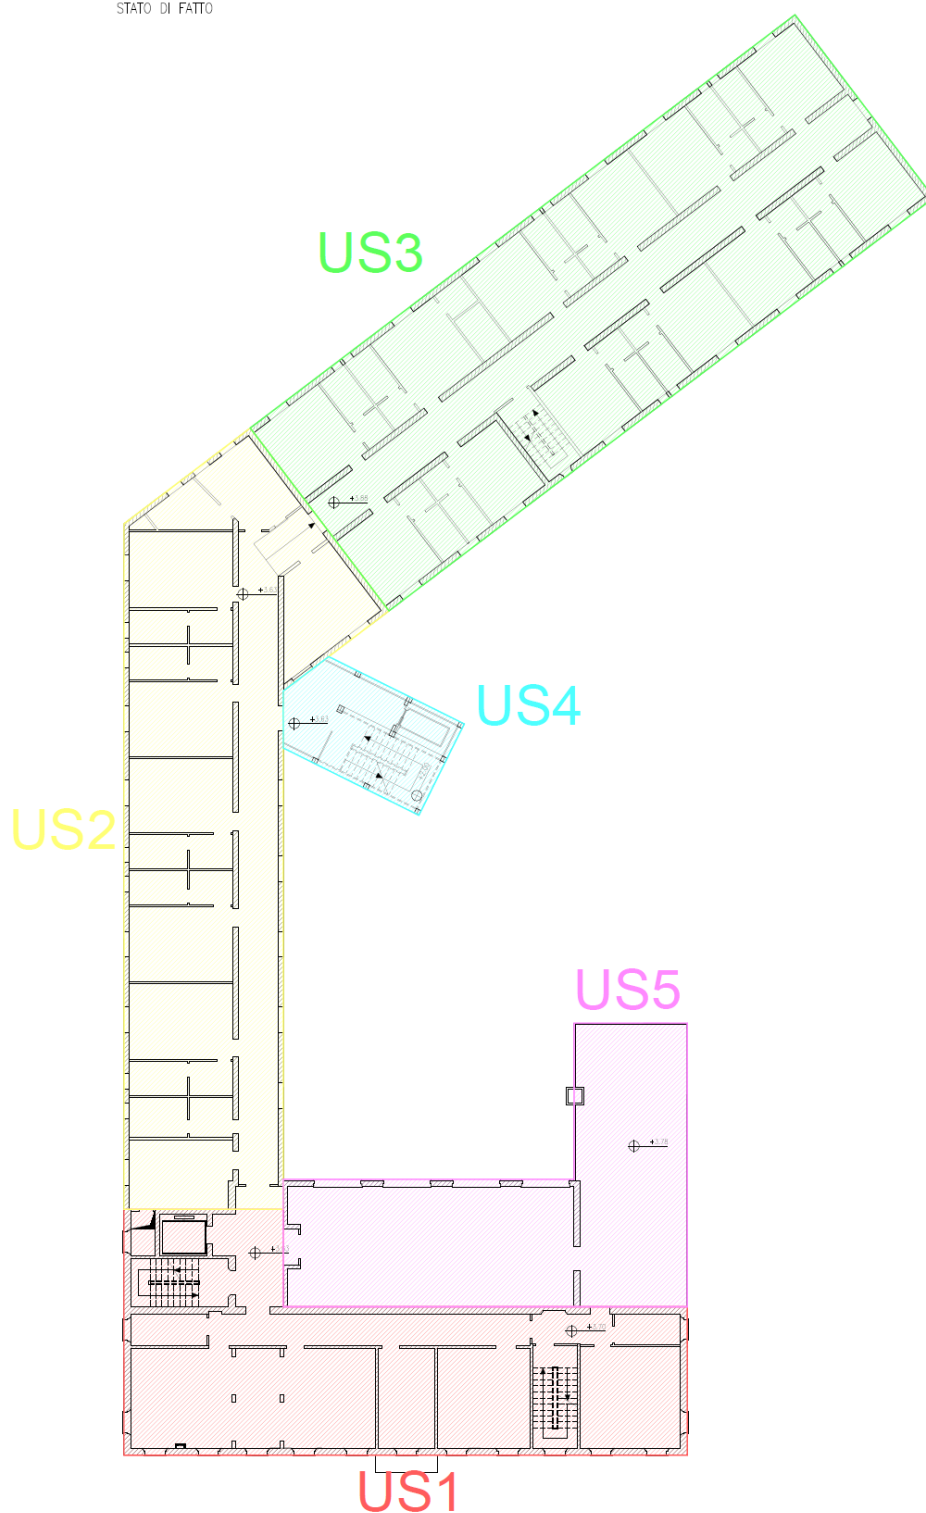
| Pianta Stato di Fatto Piano primo con indicazione differenti unità strutturali
